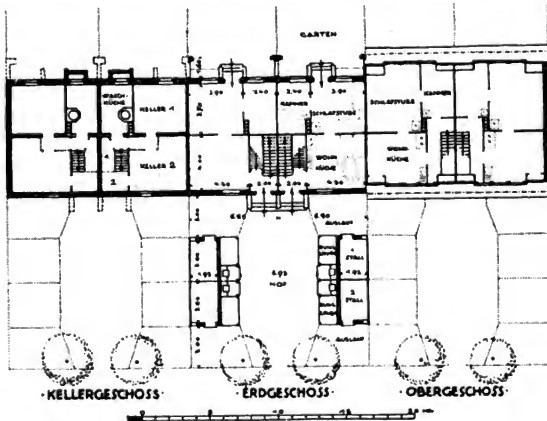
Grundrisse zu Abb. 108/109.
